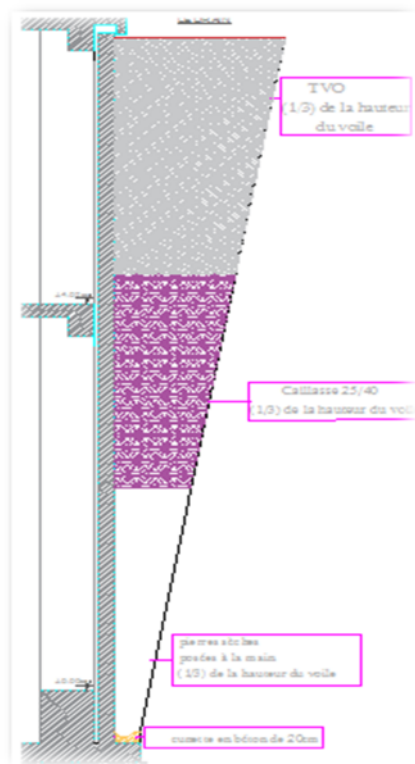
Schéma du mur plaque (Vue en élévation).
